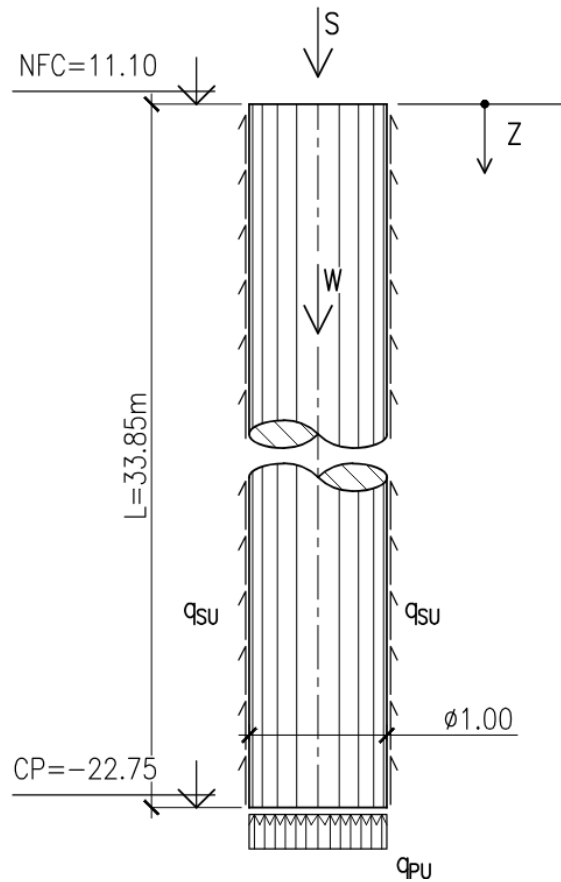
Esquema de cargas sobre el pilote.
